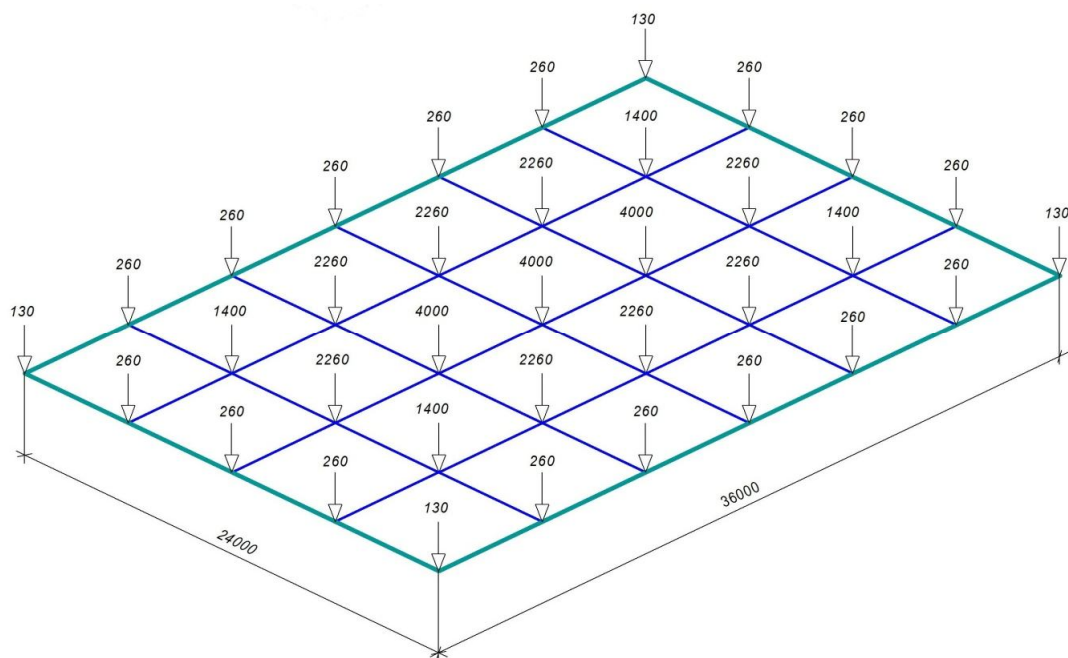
Схема перекрестного фундамента с устройством выпусков по 6 м и фундамента по периметру, сосредоточенные силы в кН
